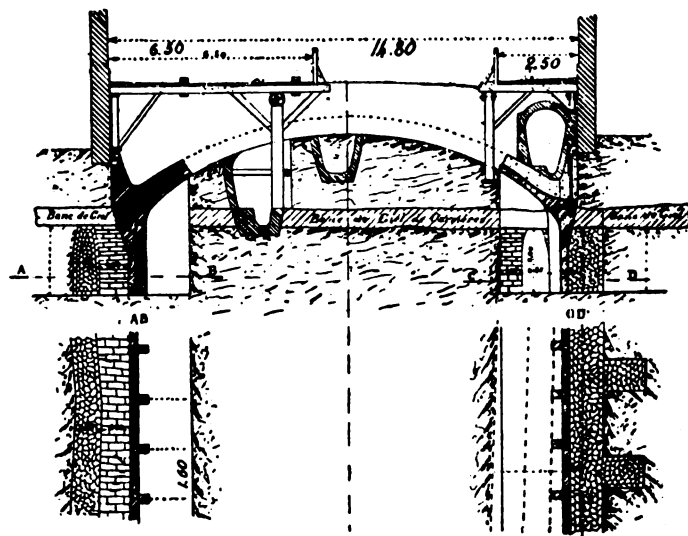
e 43. — Stazione dei Volontaires - Sezione e pianta.
